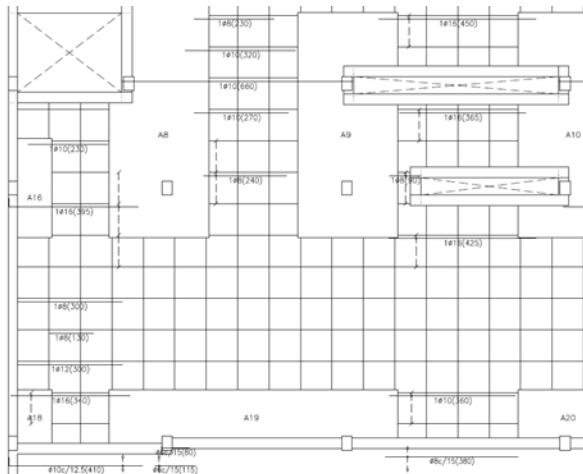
Armadura longitudinal inferior necesaria previamente a la intervención
